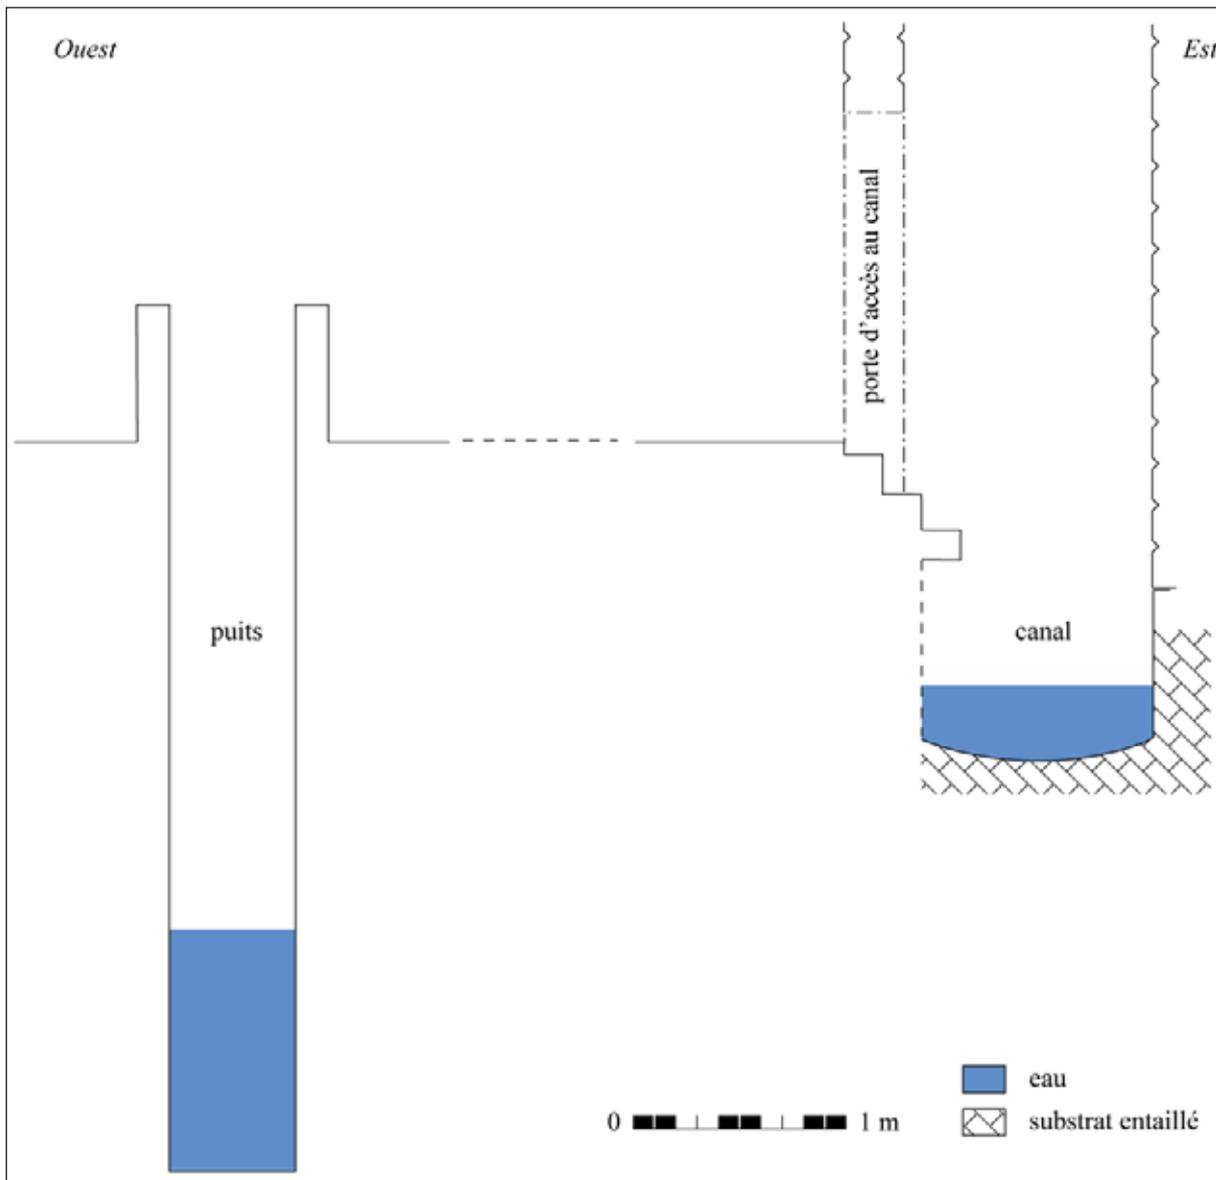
croquis à l'échelle du puits et du canal vus en coupe
